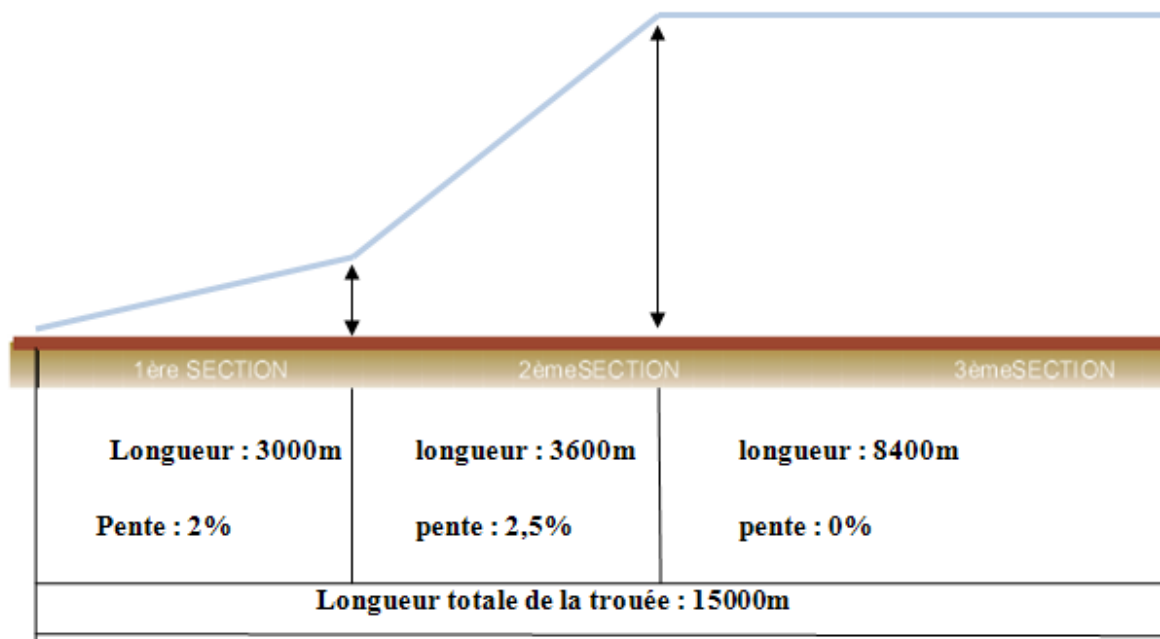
Coupe longitudinale de la trouée d'atterrissage.
